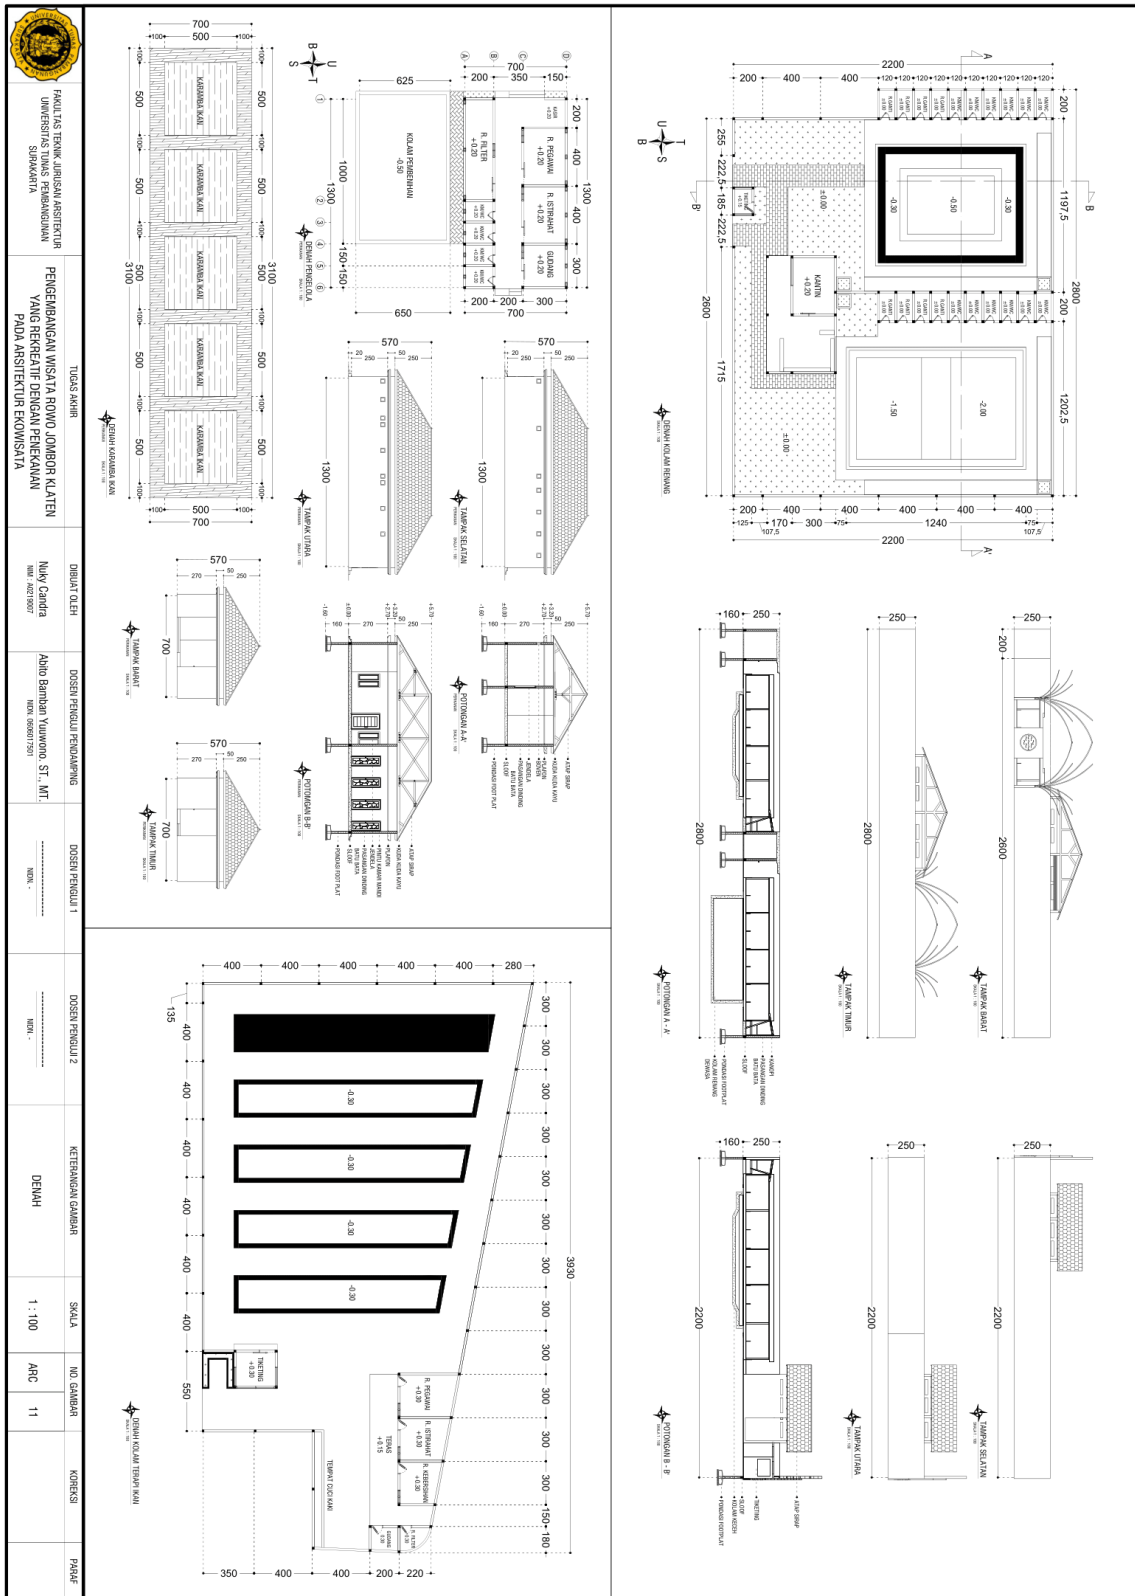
Gambar Denah, Tampak, Dan Potongan Bangunan Yang Lain
